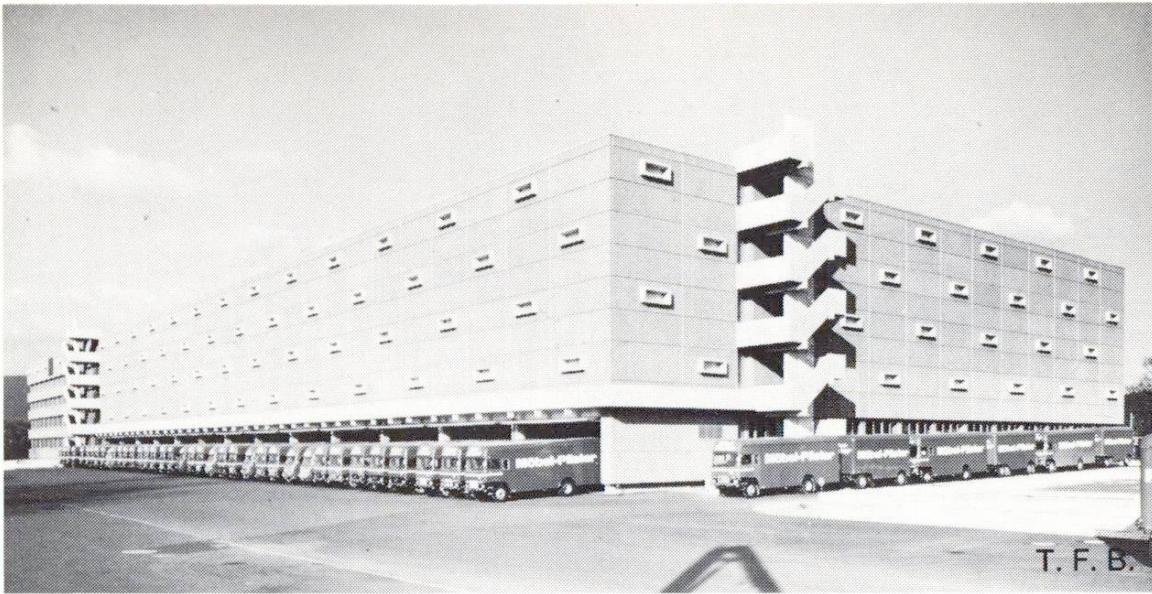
Möbellagerhaus in Suhr, Waschbetonplatten.
